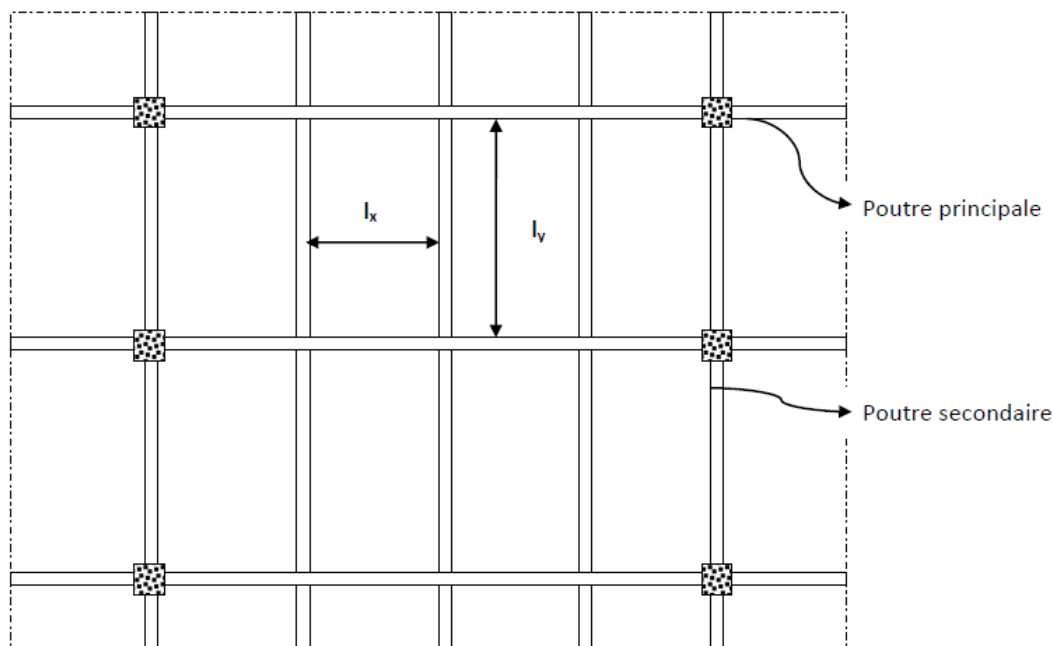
Plancher avec dalle, poutres secondaires et poutres principales
